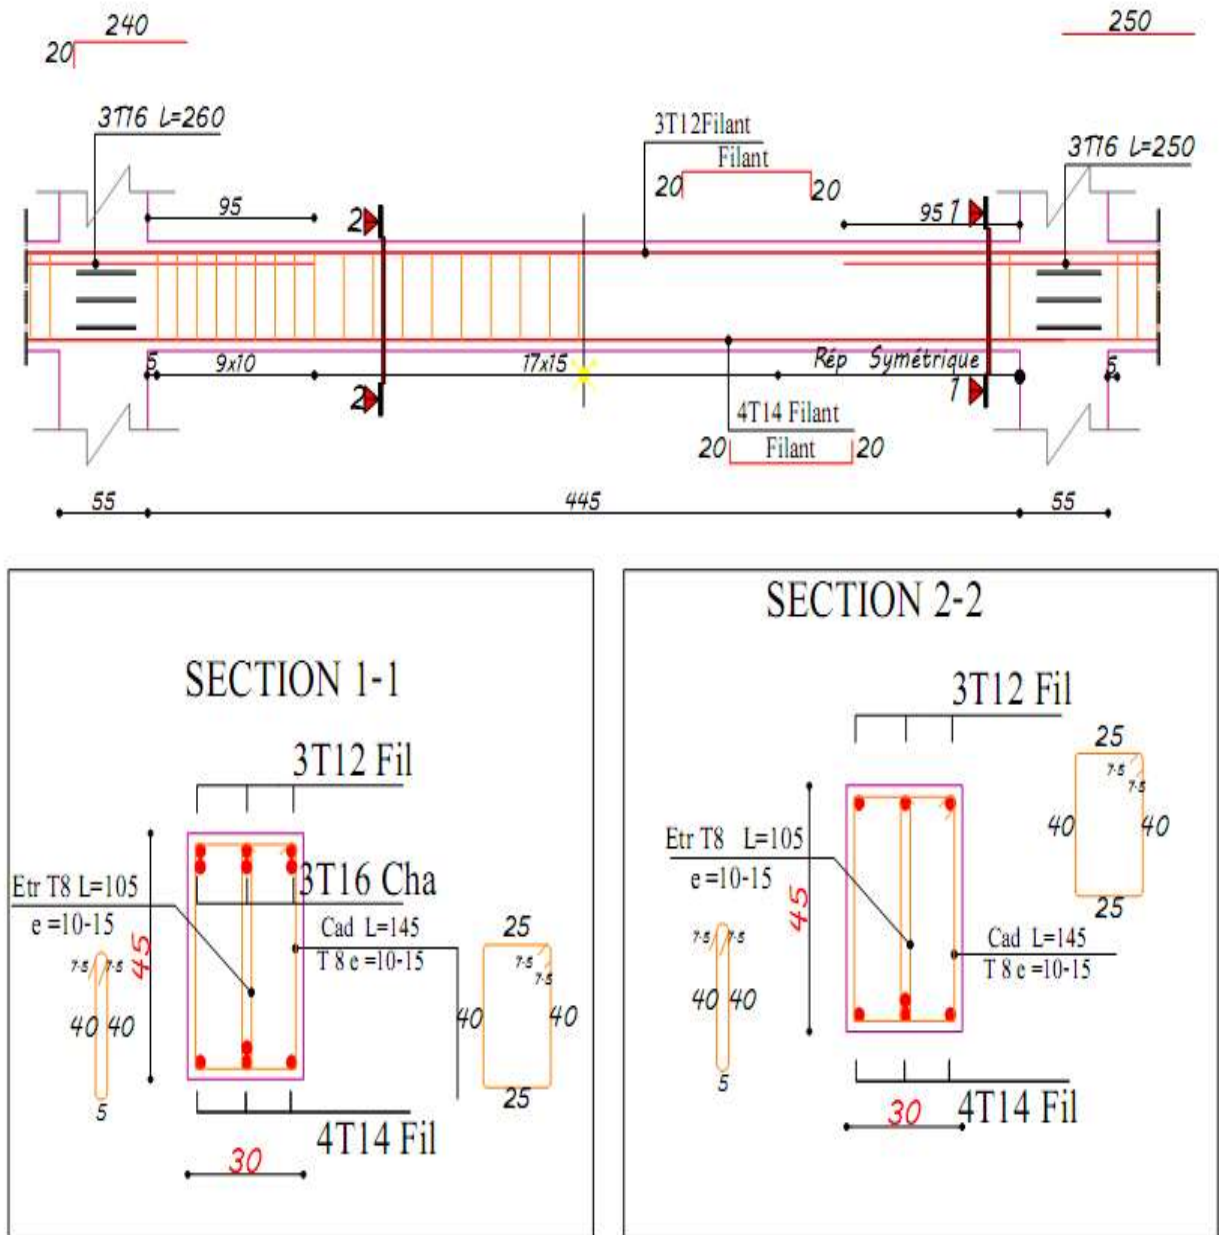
Ferrailage de poutre principale 30x45 (1 ère étage : axe B /2-3)
